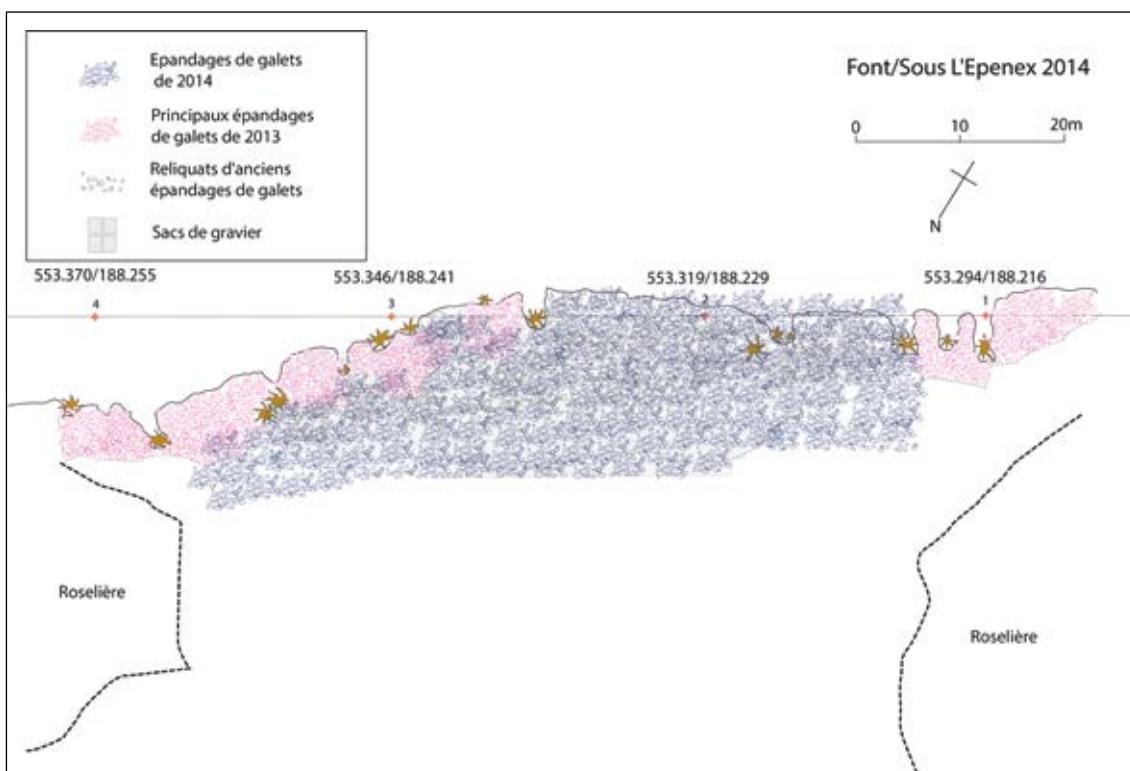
Plan de la couverture protectrice de la rive après l'opération de 2014. Plan SAEF.
